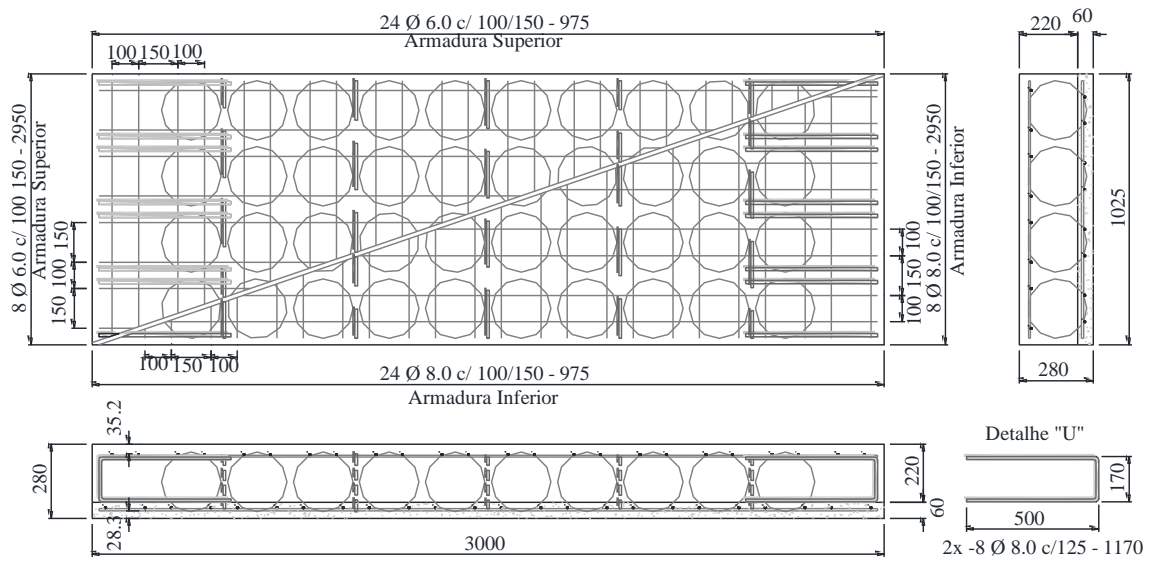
Detalhamento das armaduras de flexão da laje BD28-F1 (dimensões em mm).
